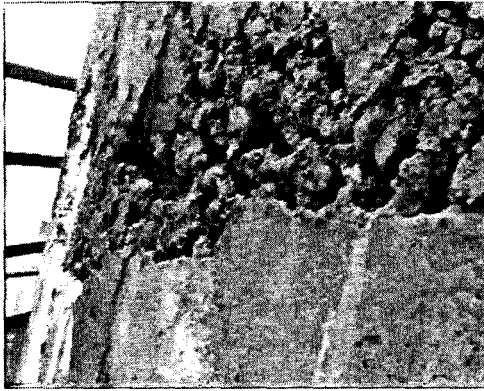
Недостатньо ущільнений бетон по шву яруса бетонування
